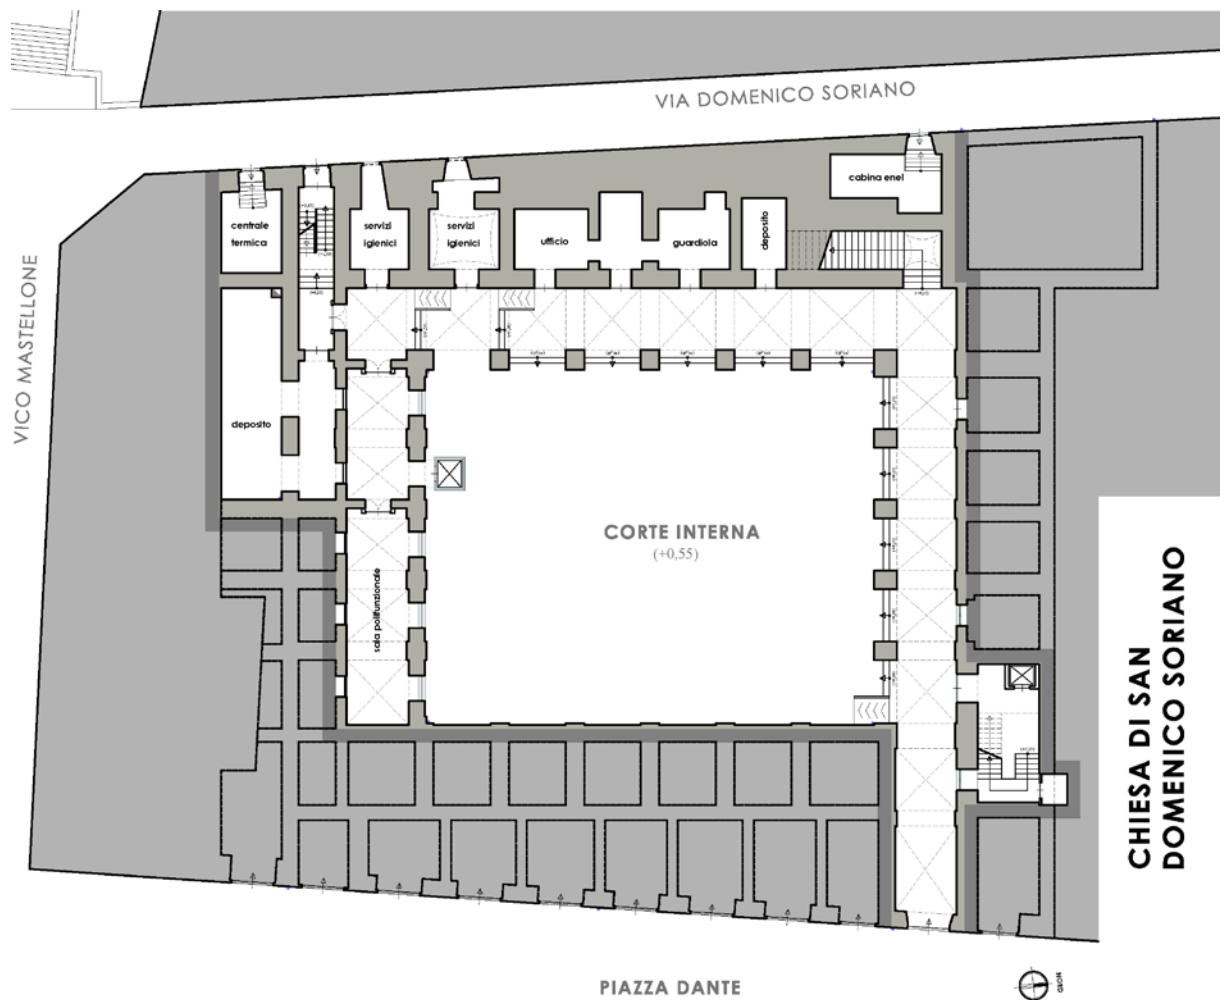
Indicazioni progettuali: Pianta Piano Terra
